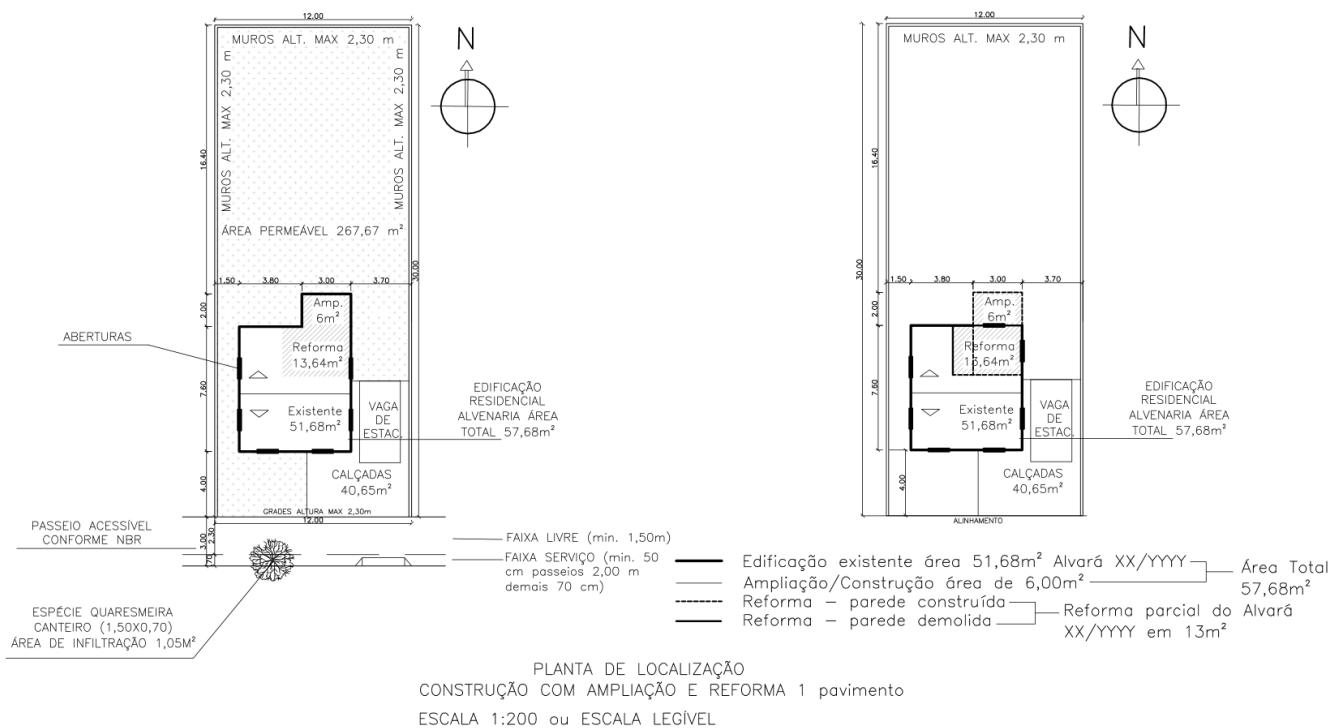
Croquis demonstrativos da planta de localização e planta de ampliação e reforma
